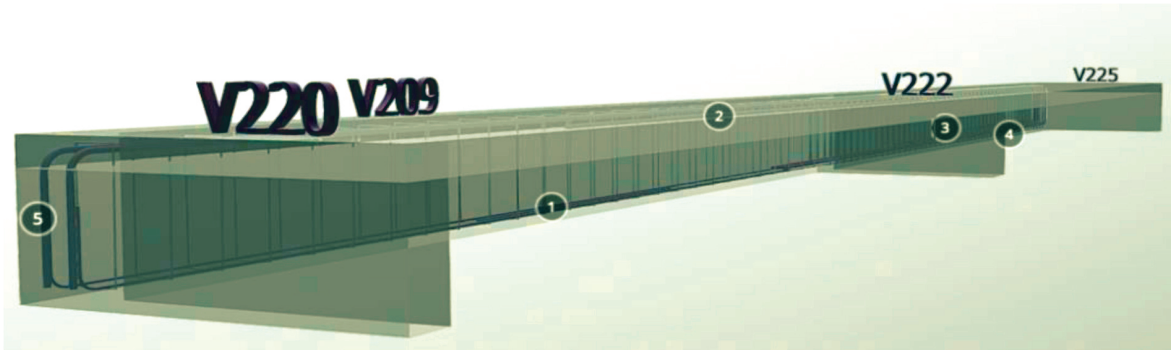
Modelo 3D en la aplicación Sketchfab para teléfono móvil
